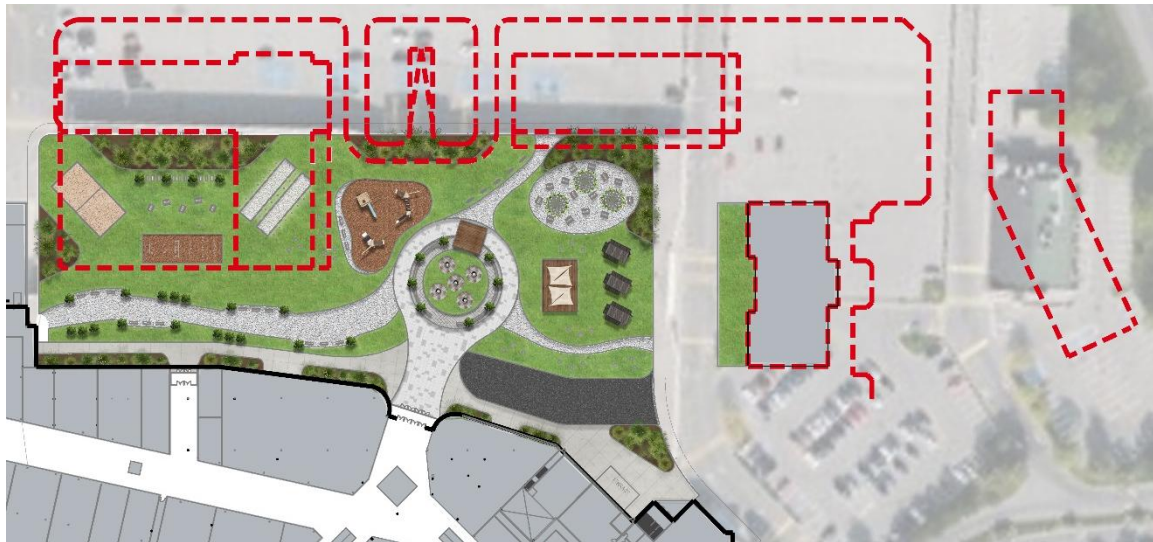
Plan illustratif de la place publique de l'étape 1 (les pointillés rouges illustrent les nouveaux futurs bâtiments, se référer au Plan de l'étape 2), pappas design studio inc.
